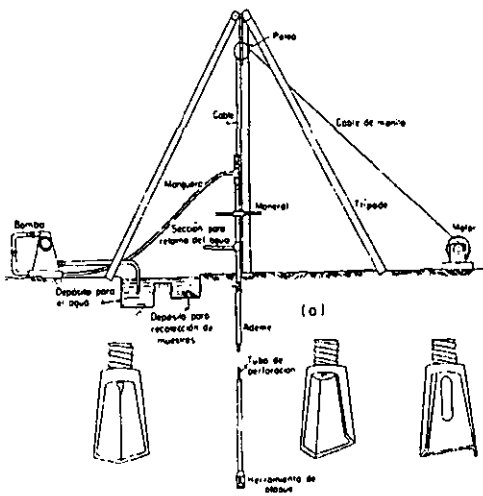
DISPOSITIVO PARA EL SONDEO POR LAVADO
